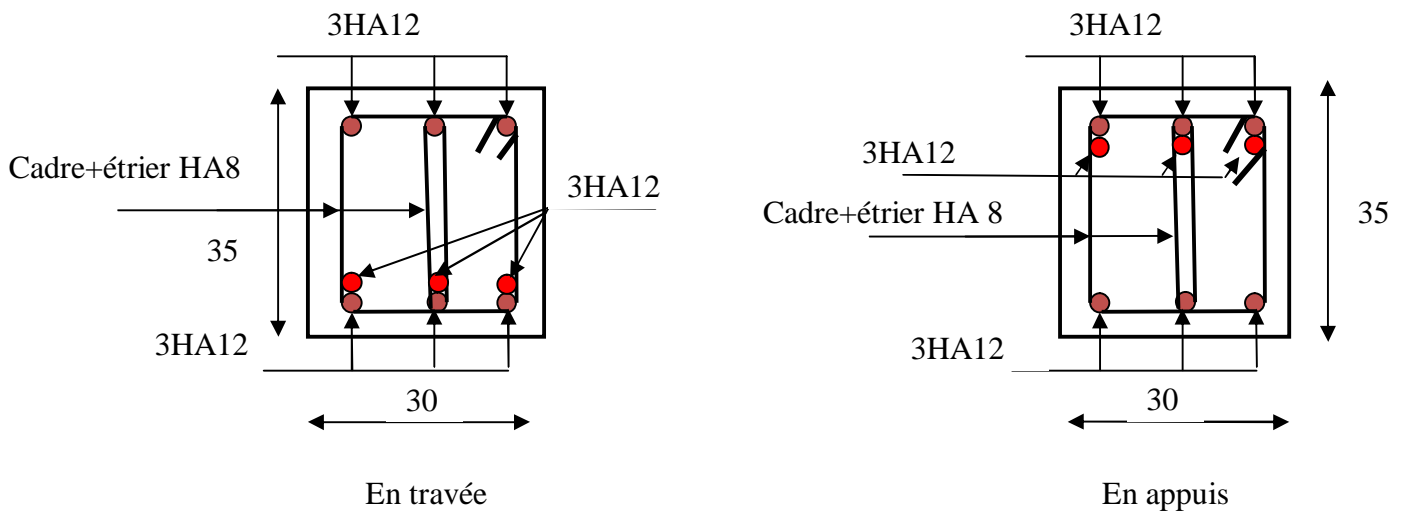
Schéma de ferrailage de la poutre secondaire pour la terrasse inaccessible.
